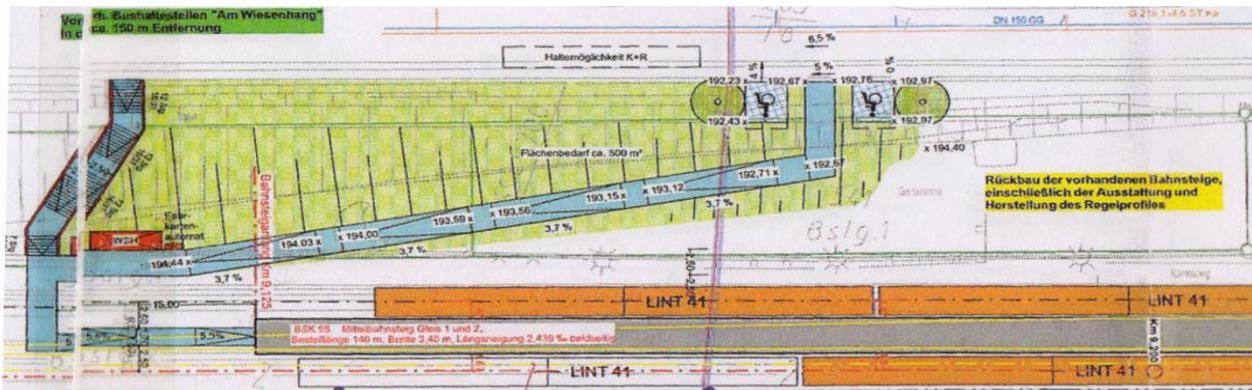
Planungsskizze Stadt Wiesbaden – Variante 4 (Auszug)
